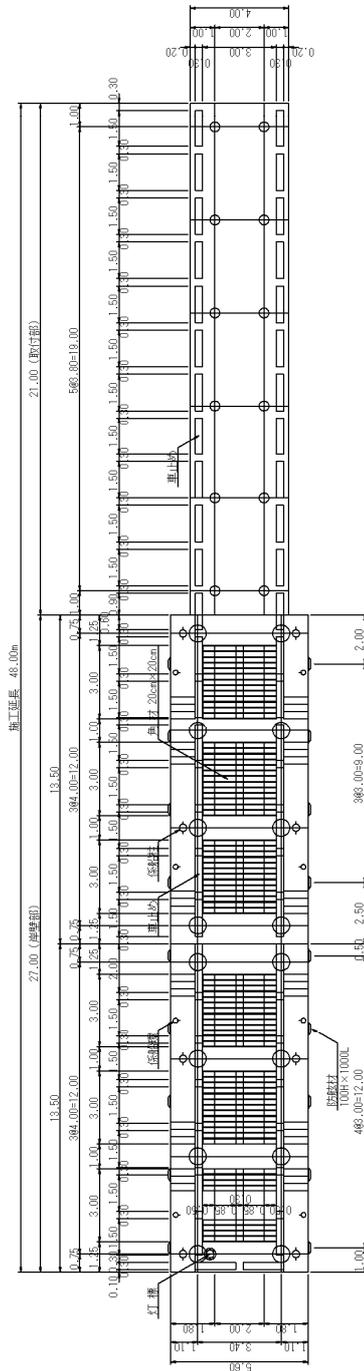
(1) 棧橋平面・断面図	図 3-2-3(9) 漁業複合棟断面図
